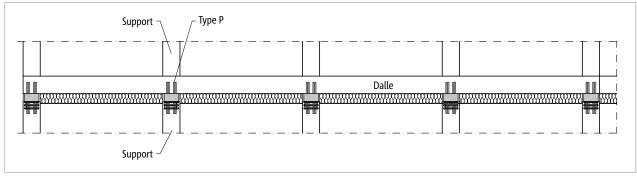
Schöck Sconnex® type P : raccordement du poteau à la dalle sus-jacente
